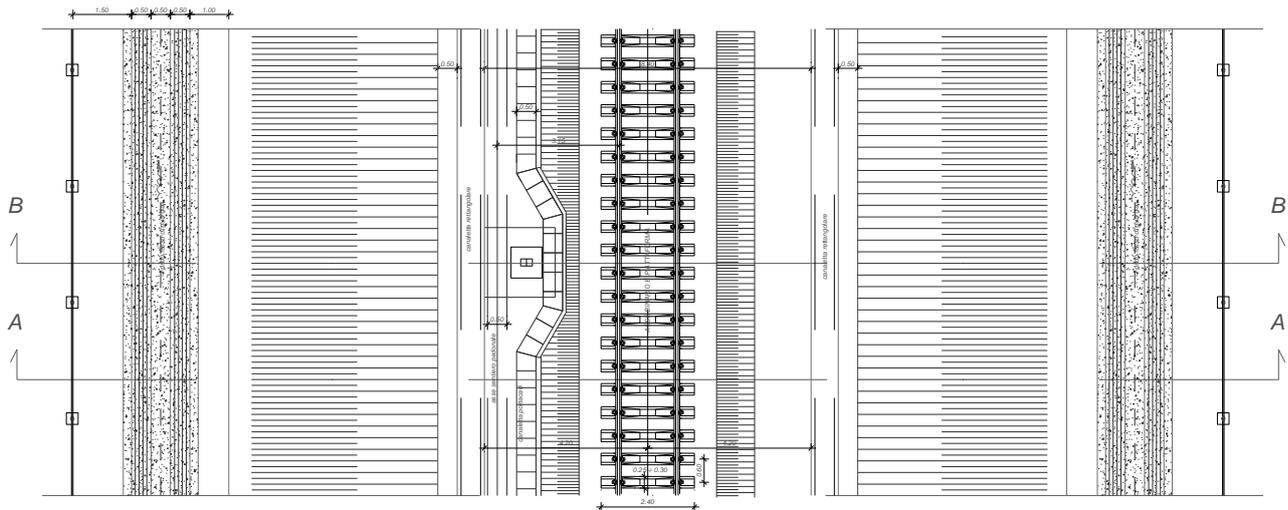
Stralcio planimetrico con sezione tipo ferroviaria in trincea a singolo binario in rettilo
